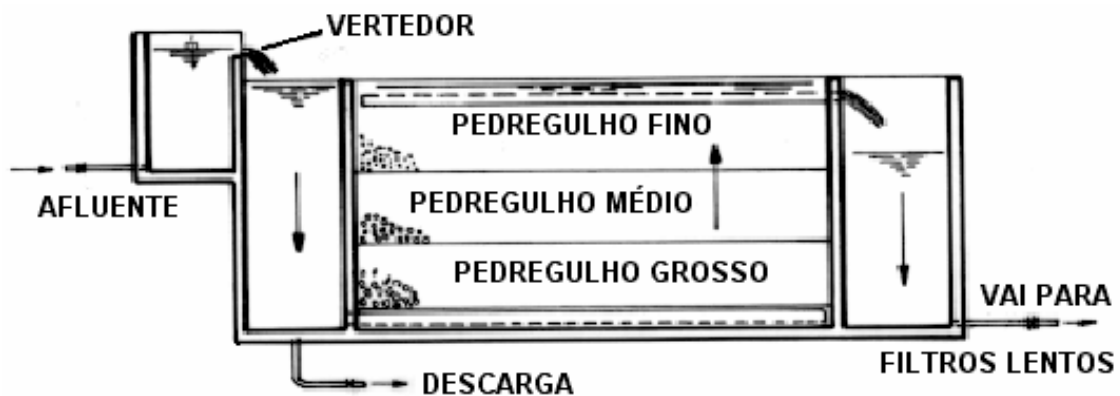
Esquema em corte de uma Instalação de PFPAC
